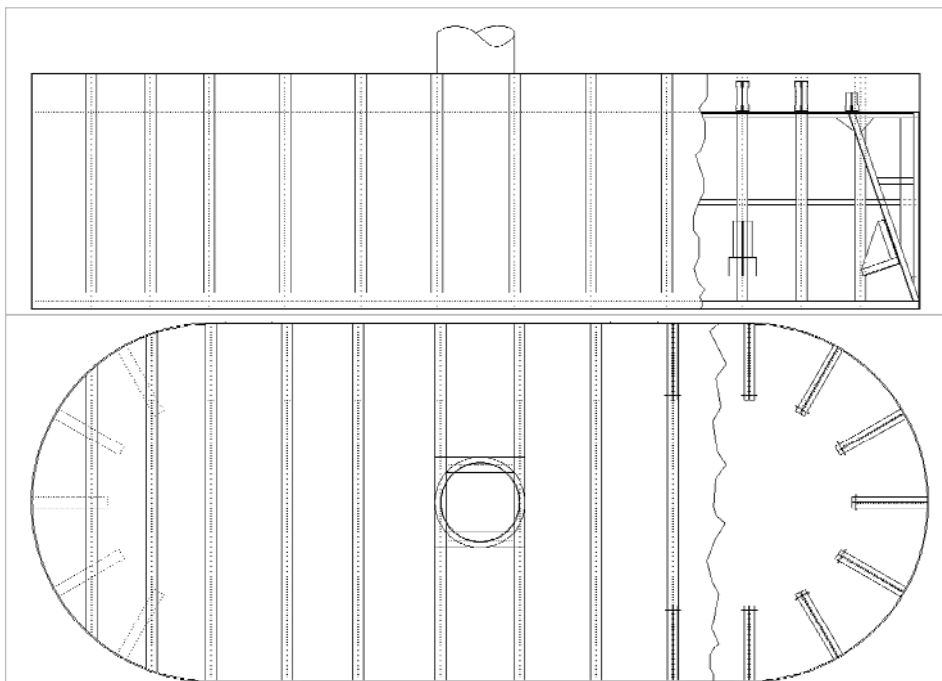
Perfil lateral e planta do caixón do pilar 1°
